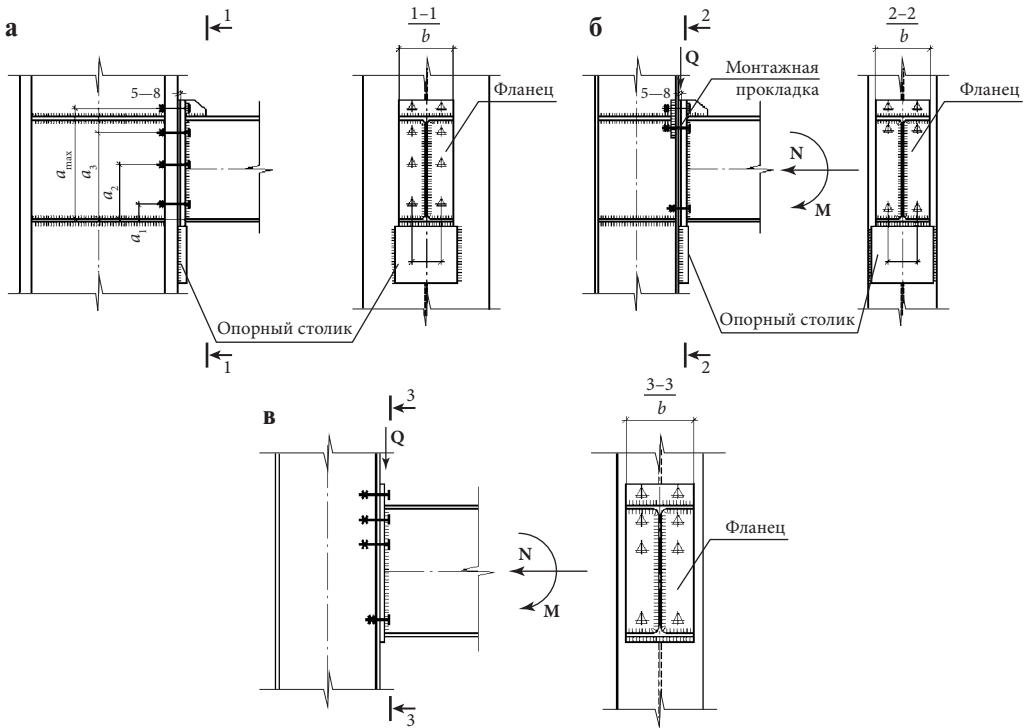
Жесткое фланцевое крепление балок к колоннам: а) фланцевое крепление к колонне с толстыми полками; б) фланцевое крепление балки к колонне с тонкими полками; в) фланцевое крепление балки к колонне с гибким фланцем без опорного столика
